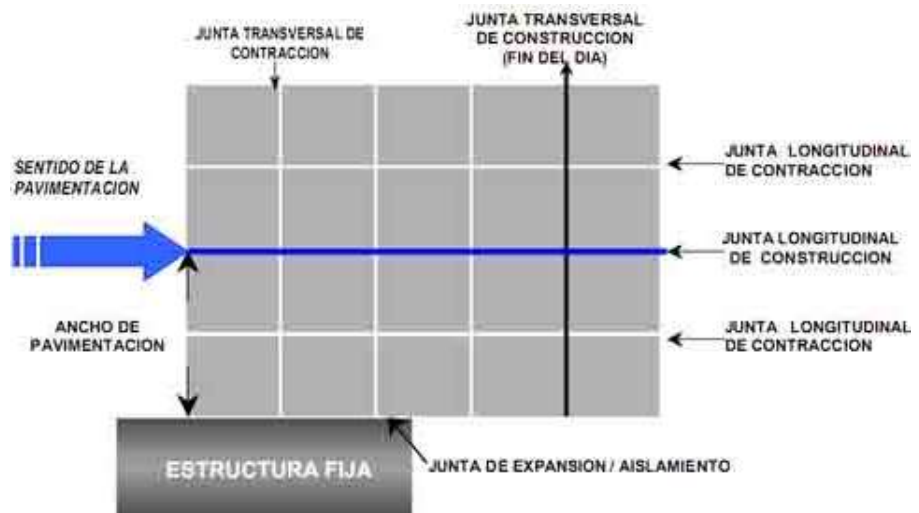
Tipos de juntas transversales y longitudinales en el pavimento.
